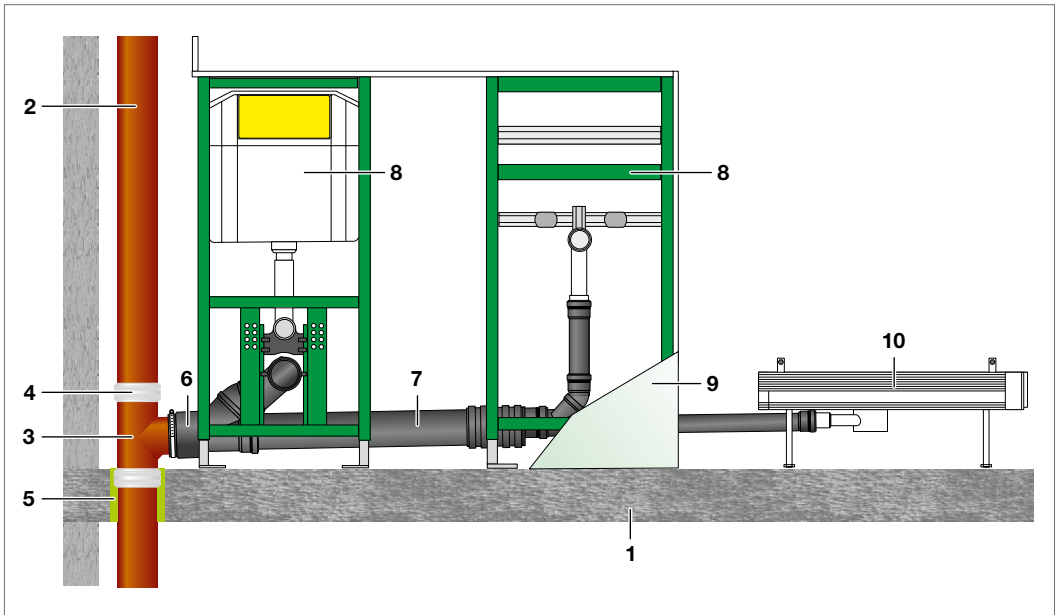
Beispiel einer Badezimmermontage in Mischinstallation nach Viega Bauartgenehmigung (aBG)
